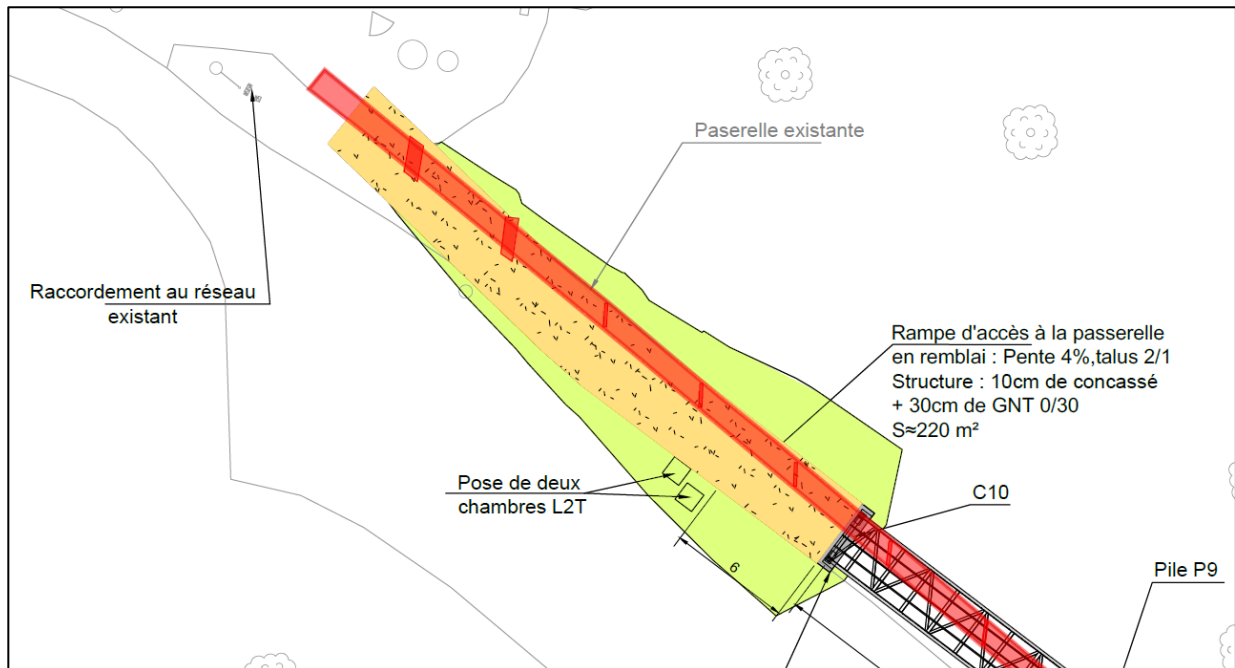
Limite de la rampe d'accès rive droite par rapport à celle existante
